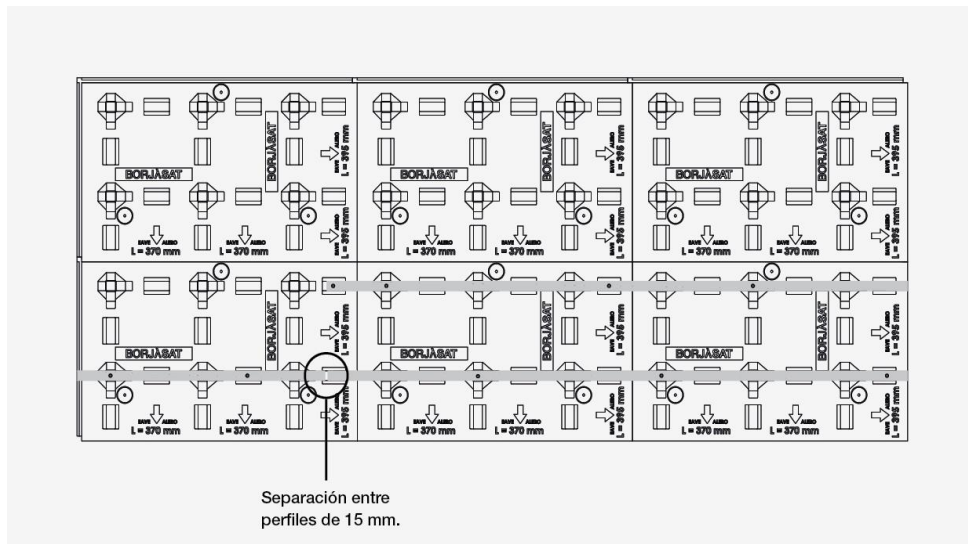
Detalles técnicos de Placa aislante λSAT y sus fijaciones a soporte
